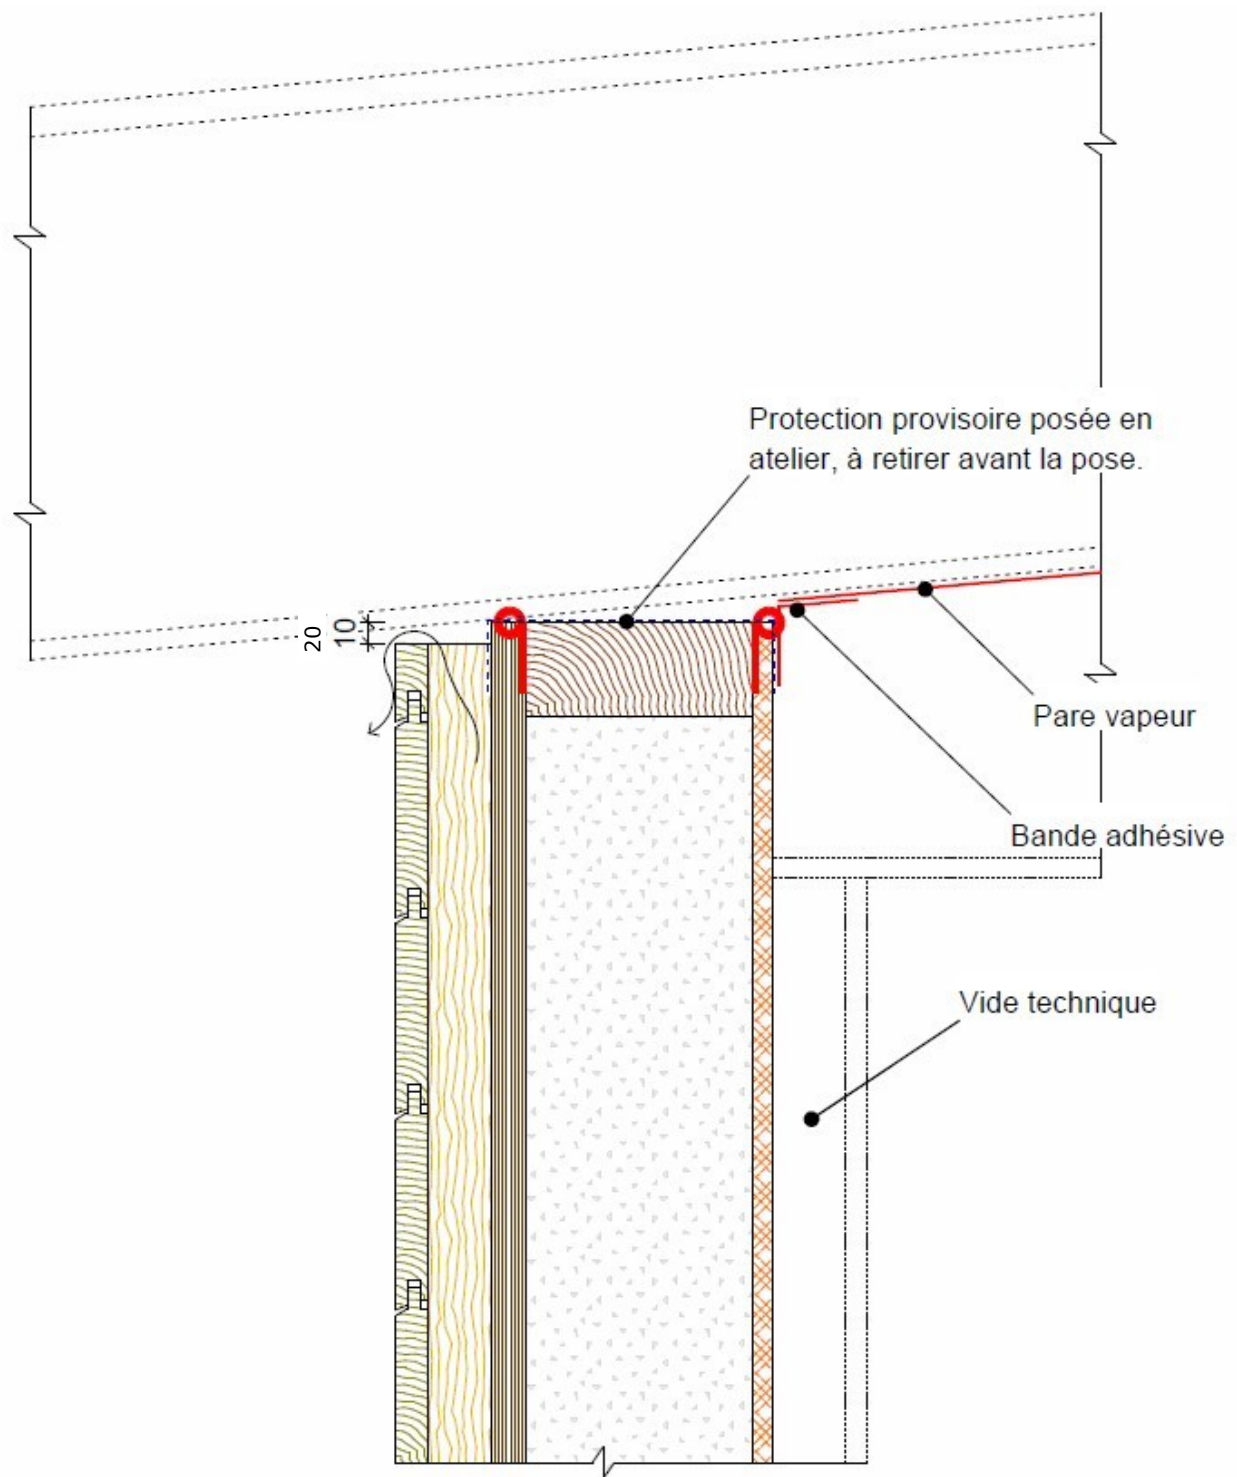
Tête de mur SYBOIS MUR – Jonction avec la toiture – Toiture préfabriquée
